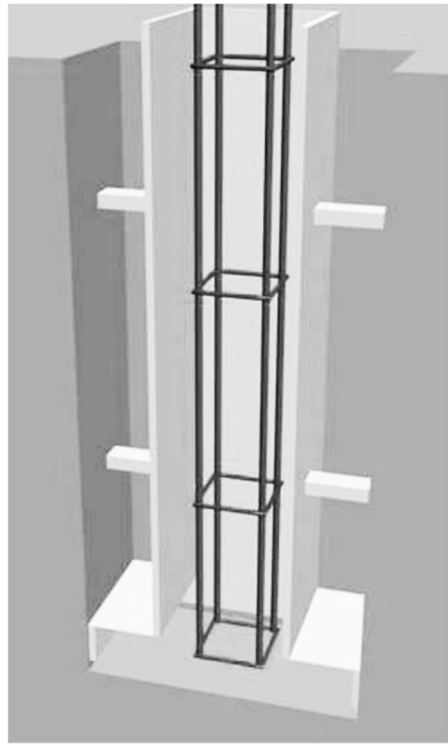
Схематичний розріз фундаменту з армованим наповненням
